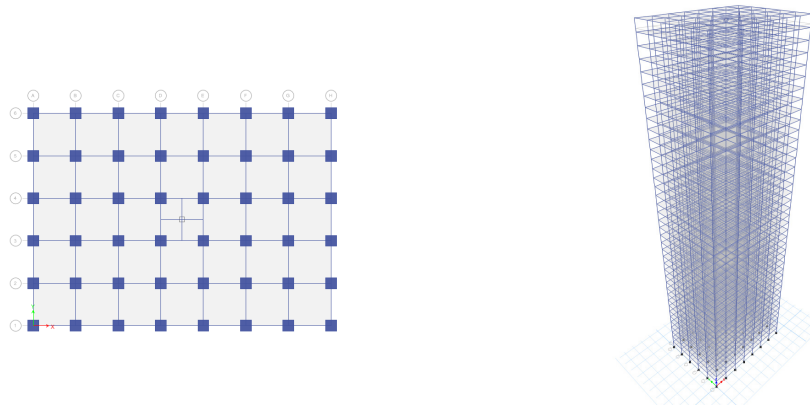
Structura cu cadre din b.a. avand forma dreptunghiulara - plan si elevatie
